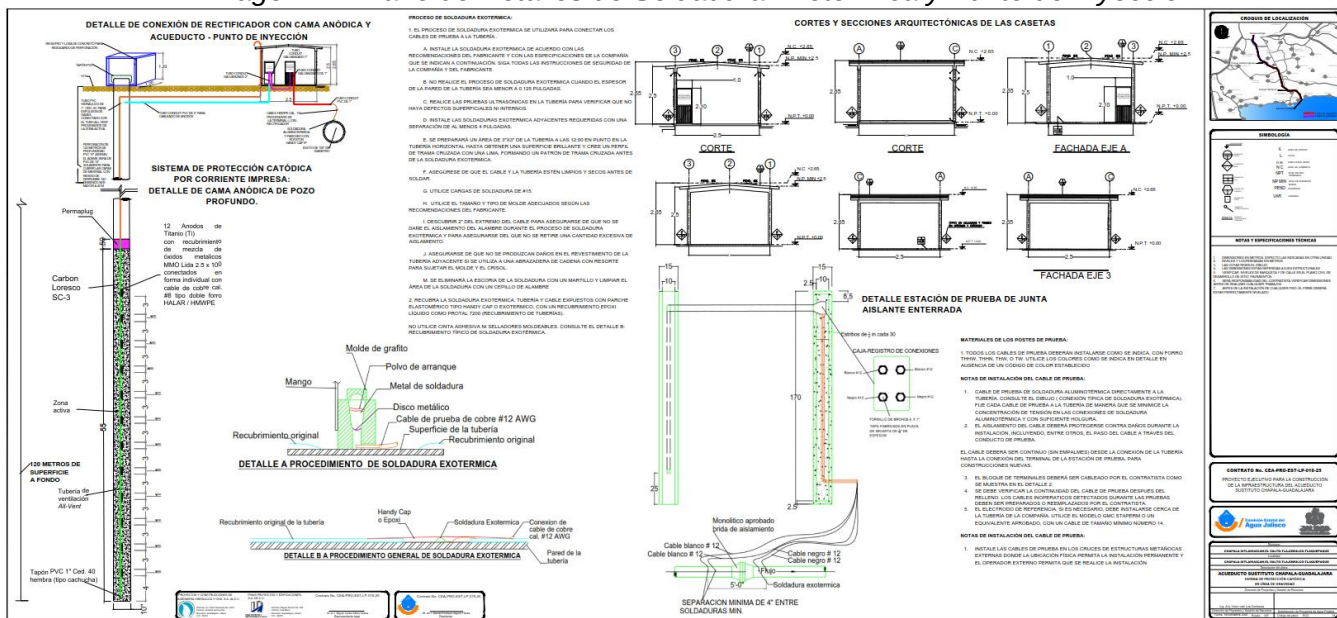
Plano de Detalles de Poste Tipo R y Soldadura Exotérmica
